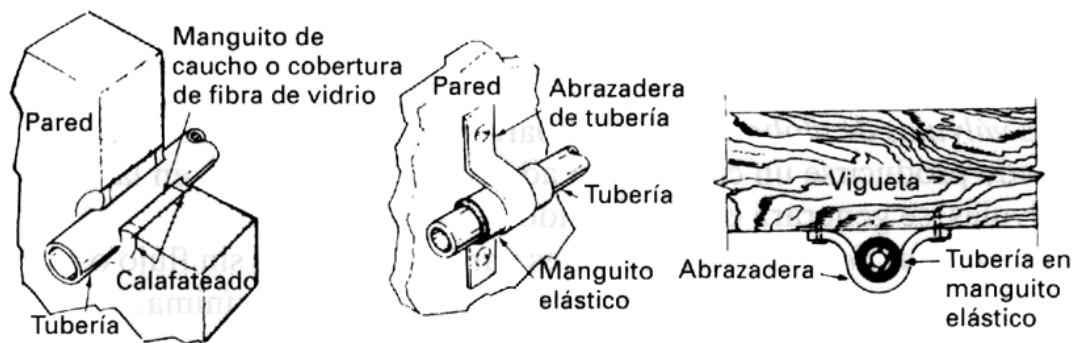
Distintas técnicas para aislar una tubería de la estructura a la que se sujeta.
